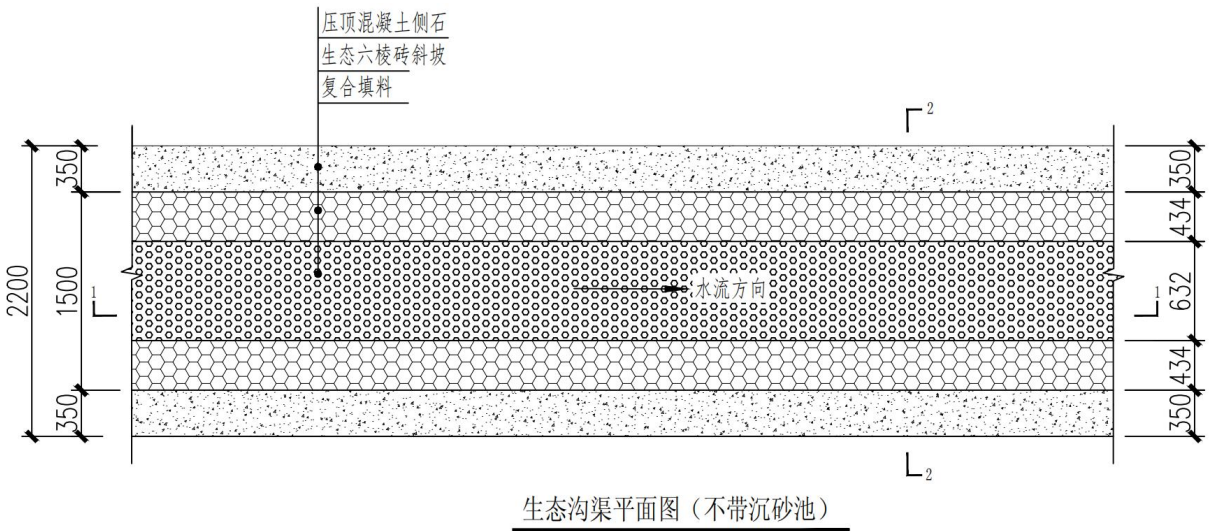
生态沟渠平面图 (不带沉砂池)
